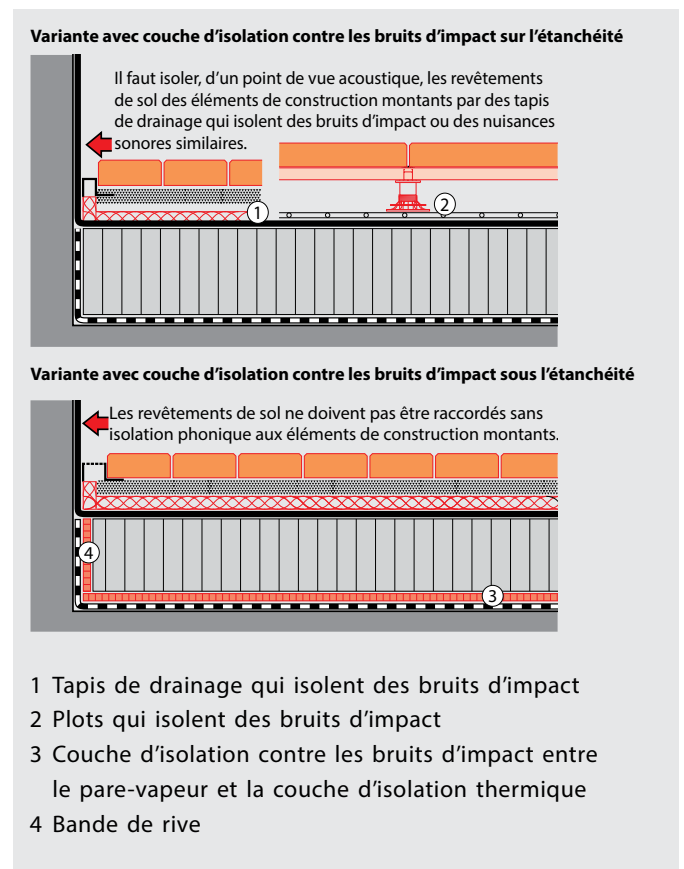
systématique de la protection contre les bruits d'impact pour les toits plats praticables.
